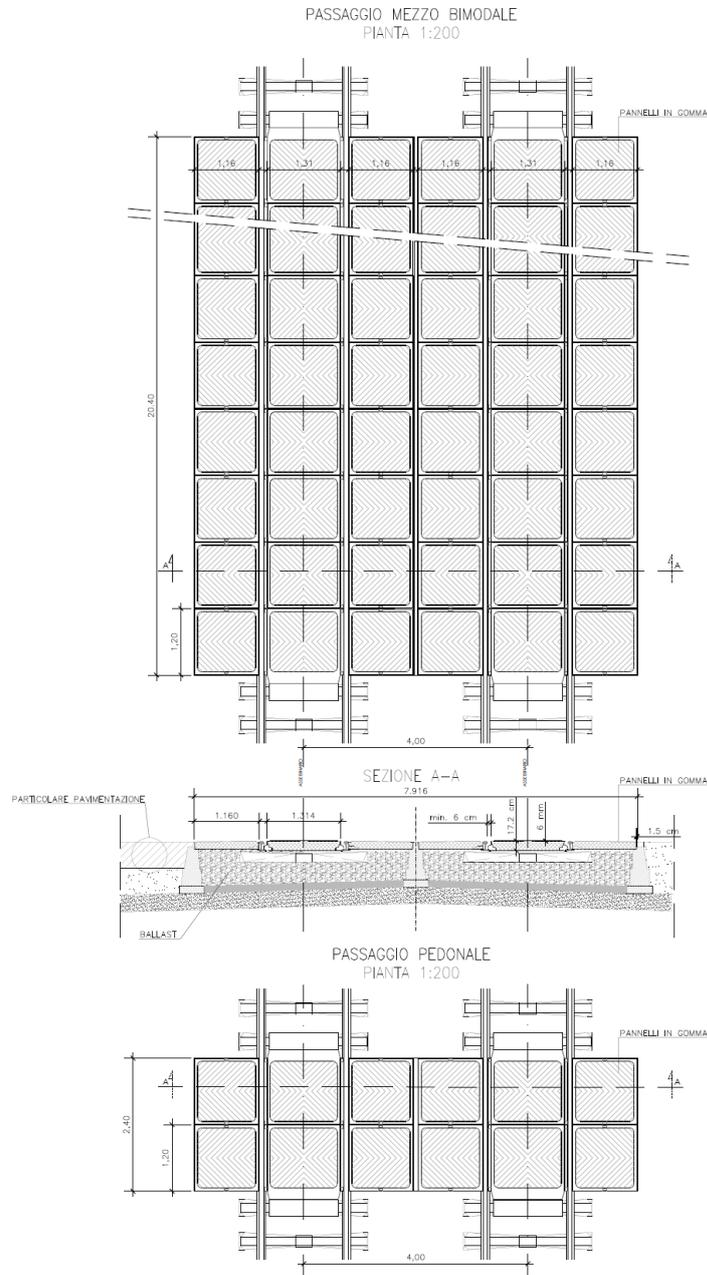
Piazzali – Dettaglio del tipologico attraversamento a raso
